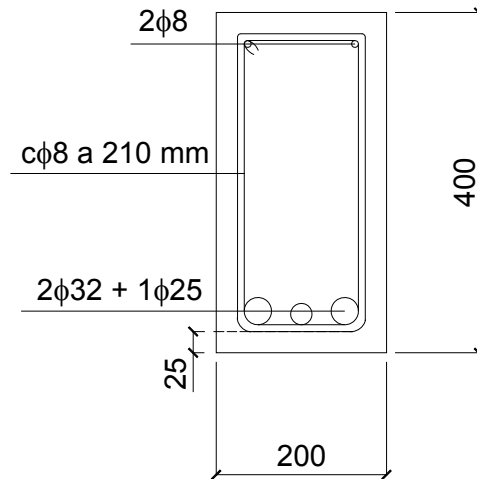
Especimen H 75/4. Cladera (2002). Sección tipo. Cotas en mm.
